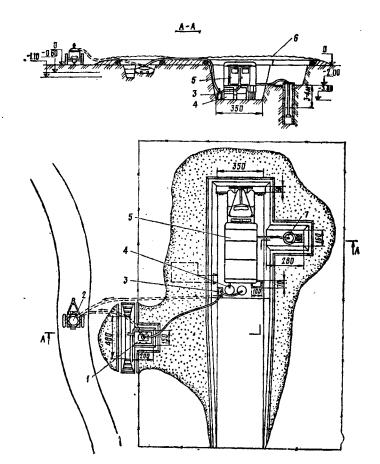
Пункт водоснабжения на передвижной опреснительной установке ПОУ-4 (вариант):
